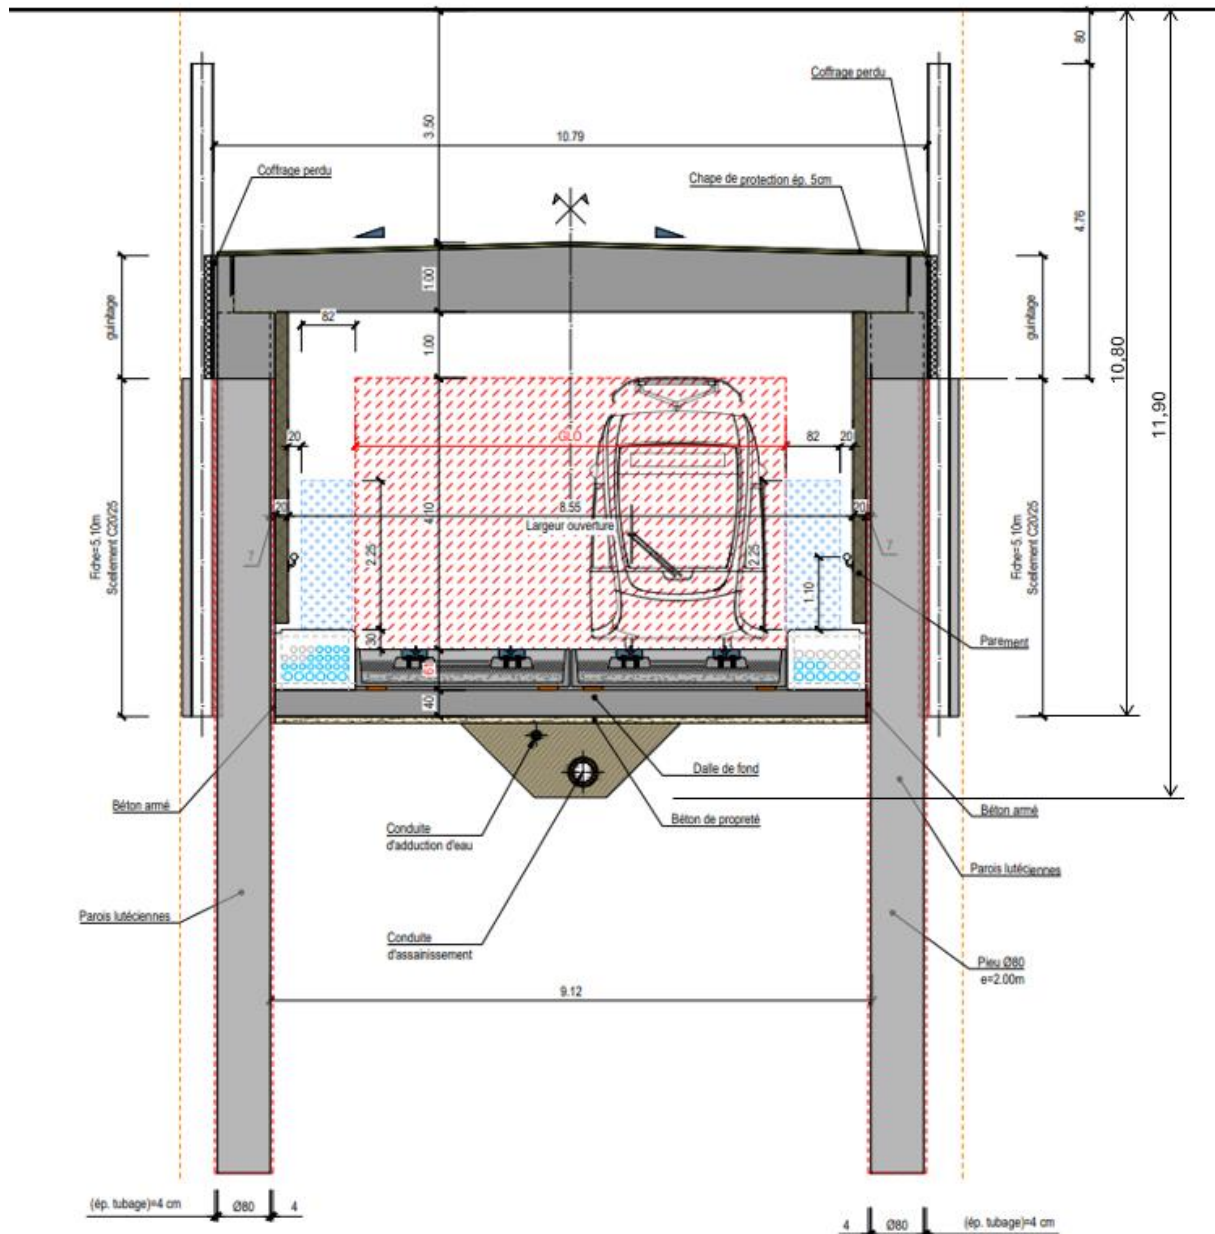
Coupe type de la tranchée couverte avec la conduite d'assainissement sous la dalle de la tranchée couverte pour récupérer les eaux d'infiltration, source : Groupement 2025
